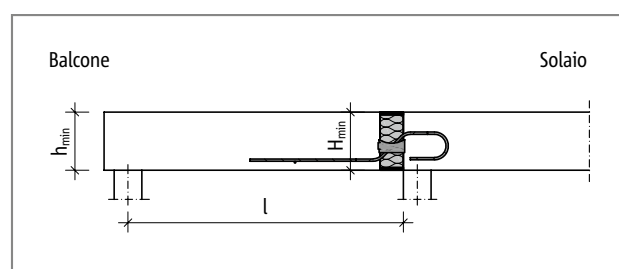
Schöck Isokorb® T tipo QP-V2 e QP-V5: schema statico
